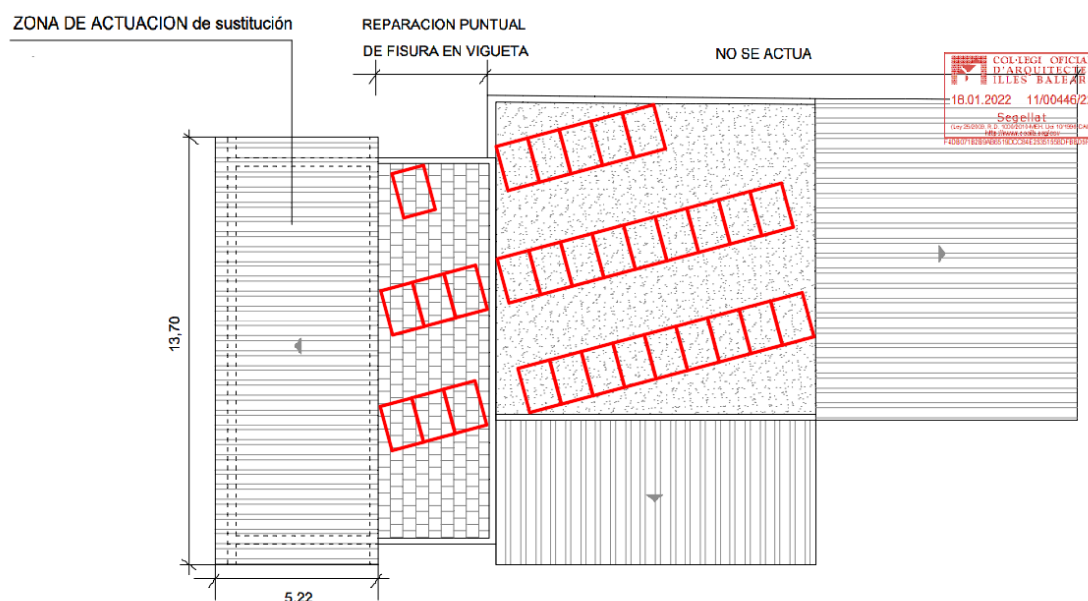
Disposición del número máximo de paneles en la cubierta horizontal
